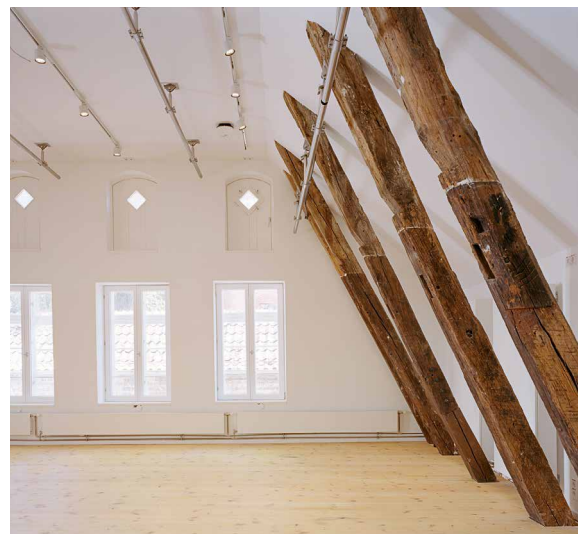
Im Dachgeschoss des Bestandsbaus Kolk 14 ist die 66 m² große Probenbühne untergebracht [© Konermann Siegmund Architekten BDA Stadtplaner / Alexander de Cuveland]
